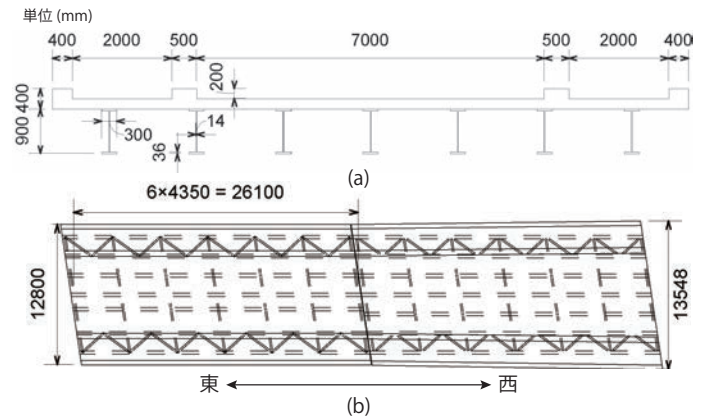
樋ノ詰橋の (a) 断面図 (b) 平面図
